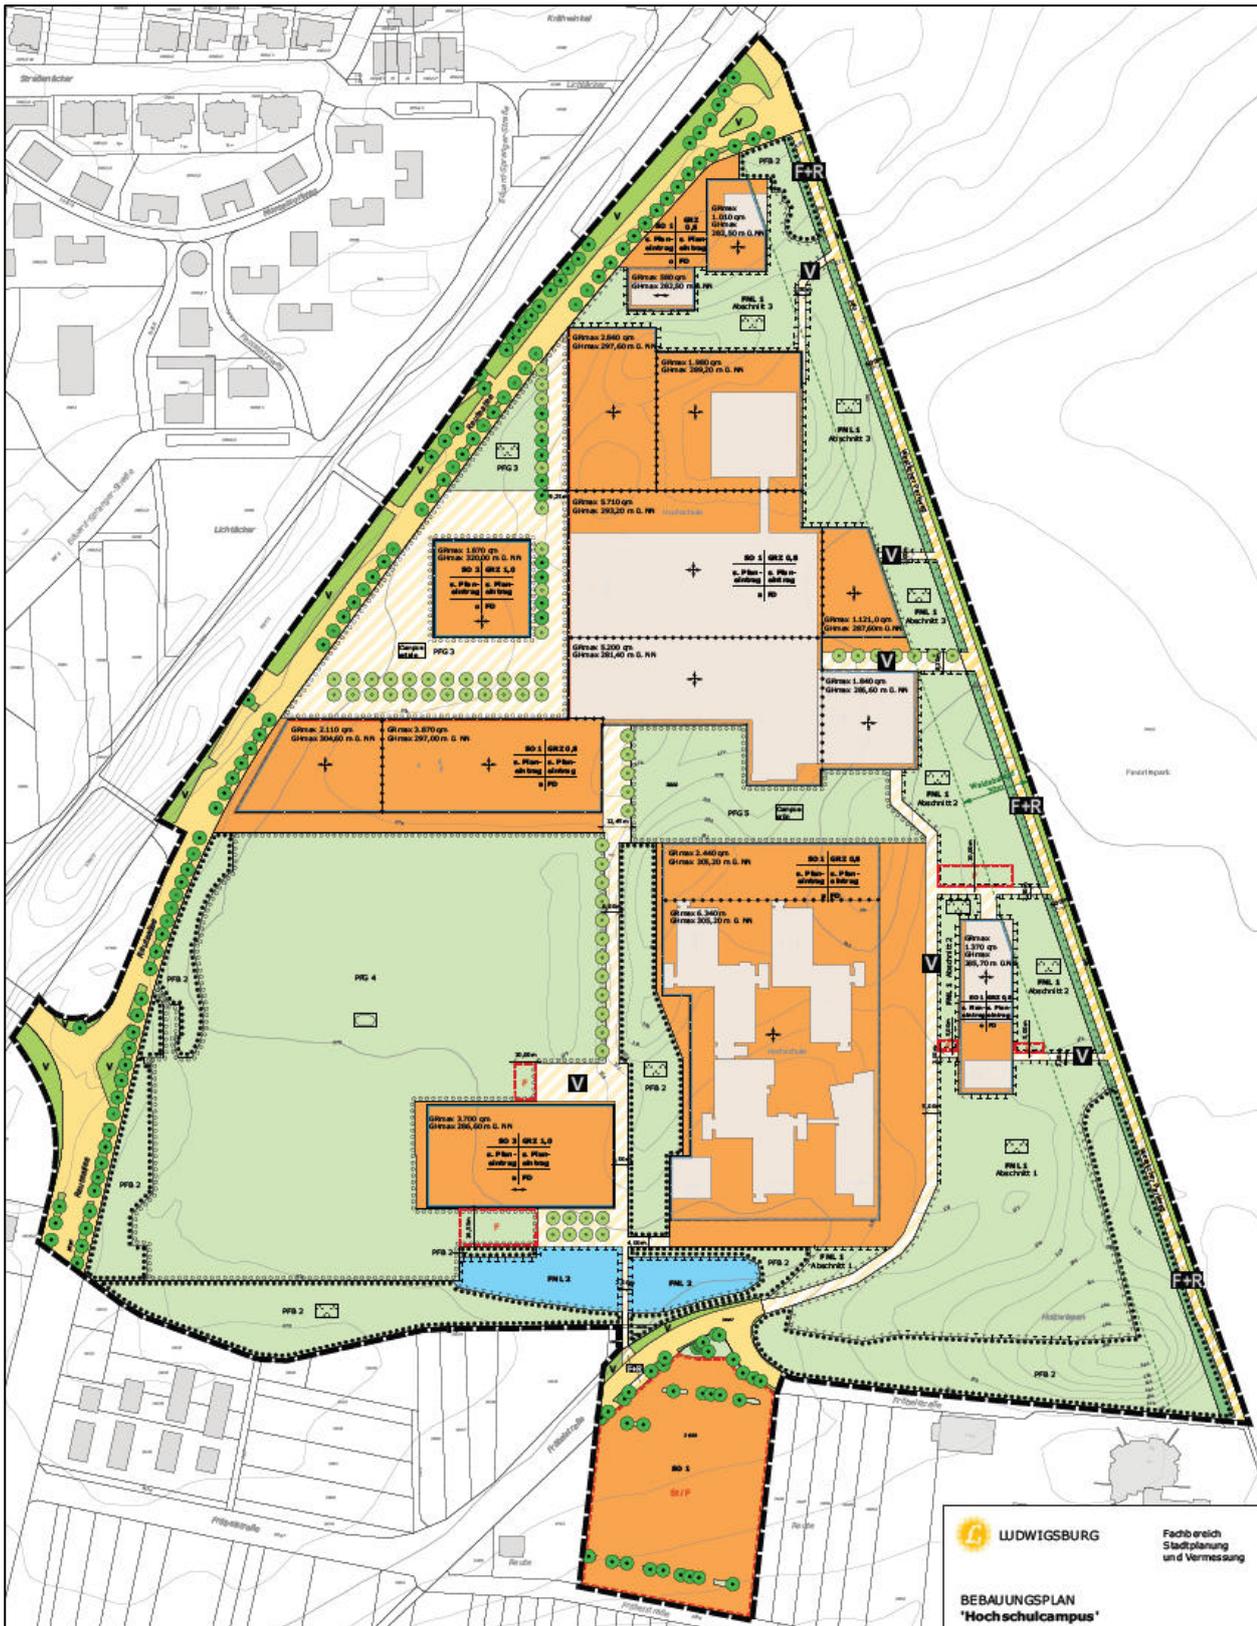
Bebauungsplan „Hochschulcampus“, Stadt Ludwigsburg
